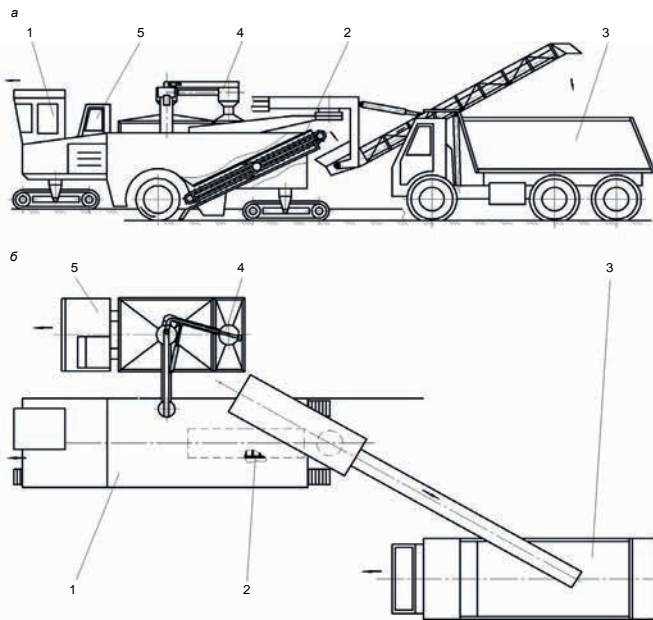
Комплекс горного оборудования для открытой разработки угольного месторождения. а – общий вид комплекса; б – вид комплекса сверху; 1 – усовершенствованный карьерный комбайн; 2 – транспортно-сортировочный агрегат; 3 – автосамосвал; 4 – пневмотранспортная система; 5 – транспортное средство.
